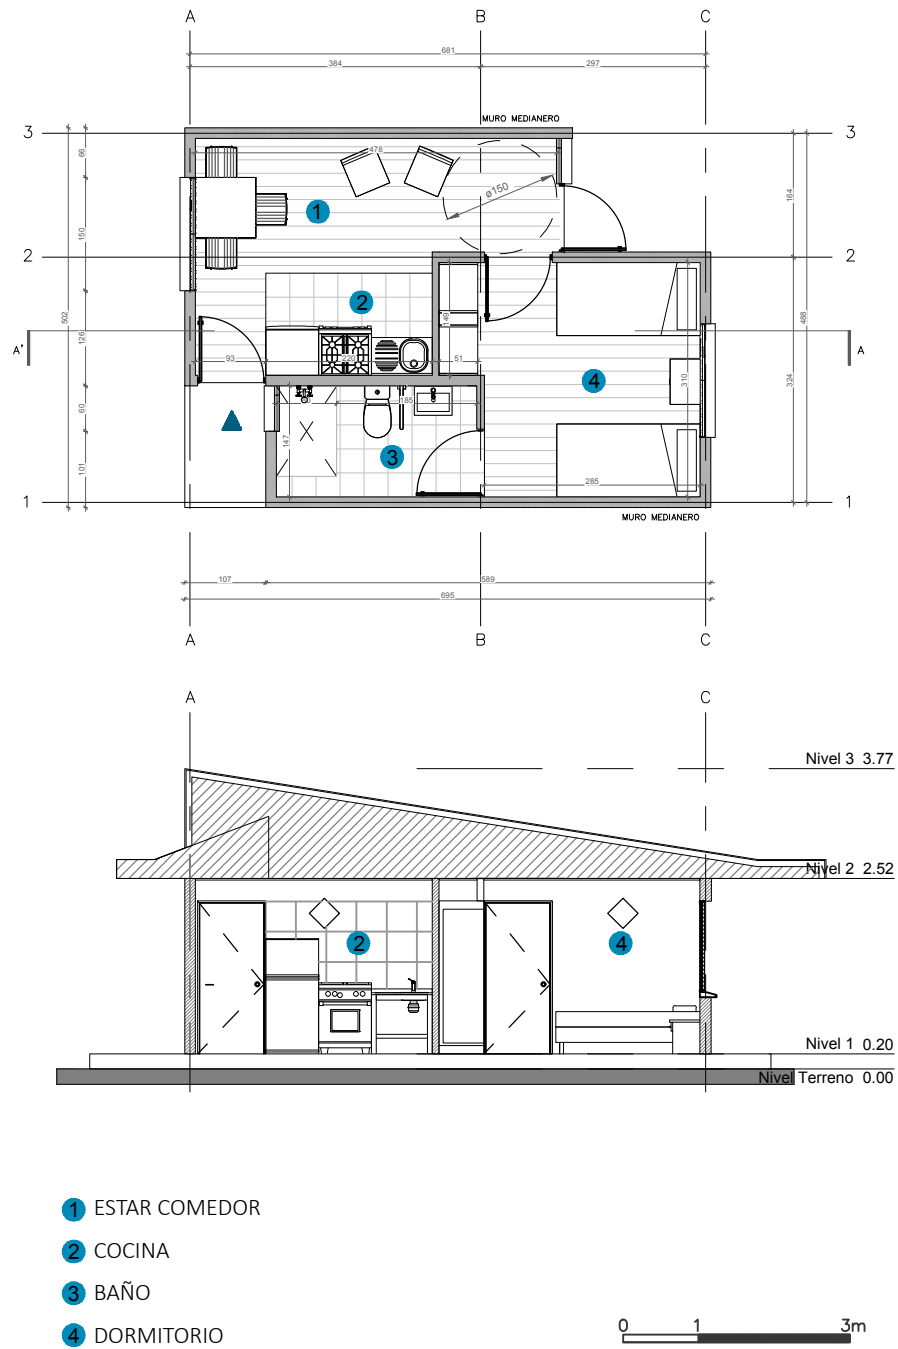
Planta y corte de una vivienda tipo CVT Natales.
